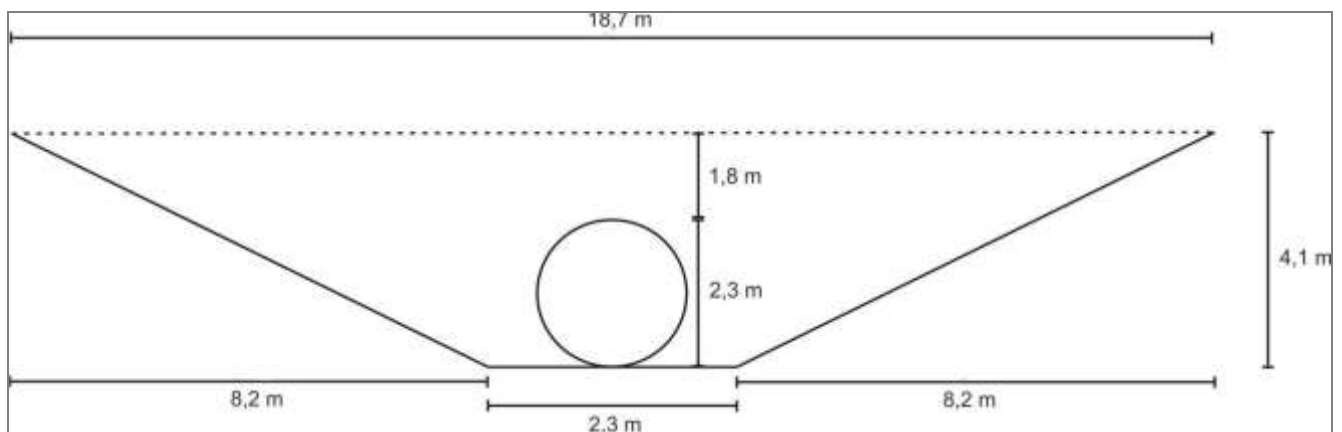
Medidas de la zanja a escavar para instalar la cañería.
